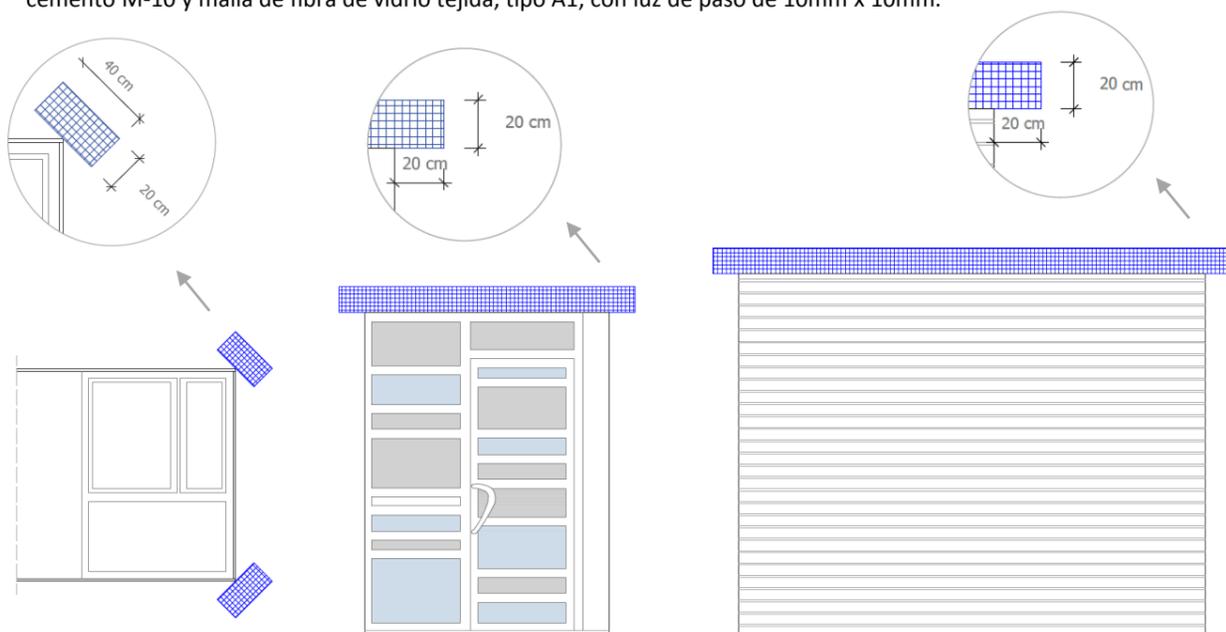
Reparación fisuras dinteles. 2018. Elaboración propia
